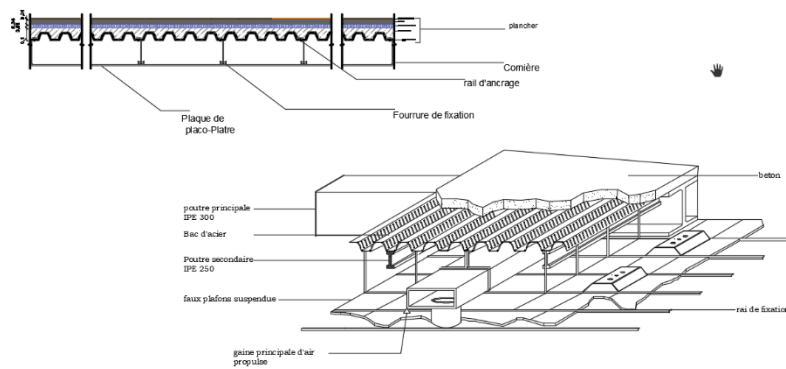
DETAIL PLANCHER COLLABORANT.
